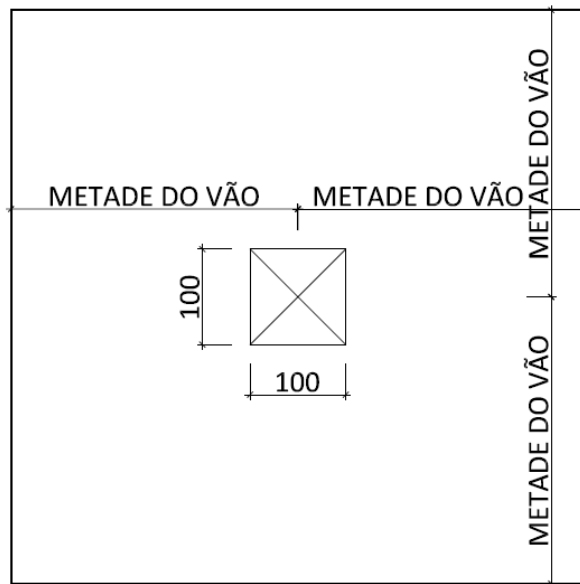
Abertura centralizada a 1 metro da face da laje (Posição 2).
